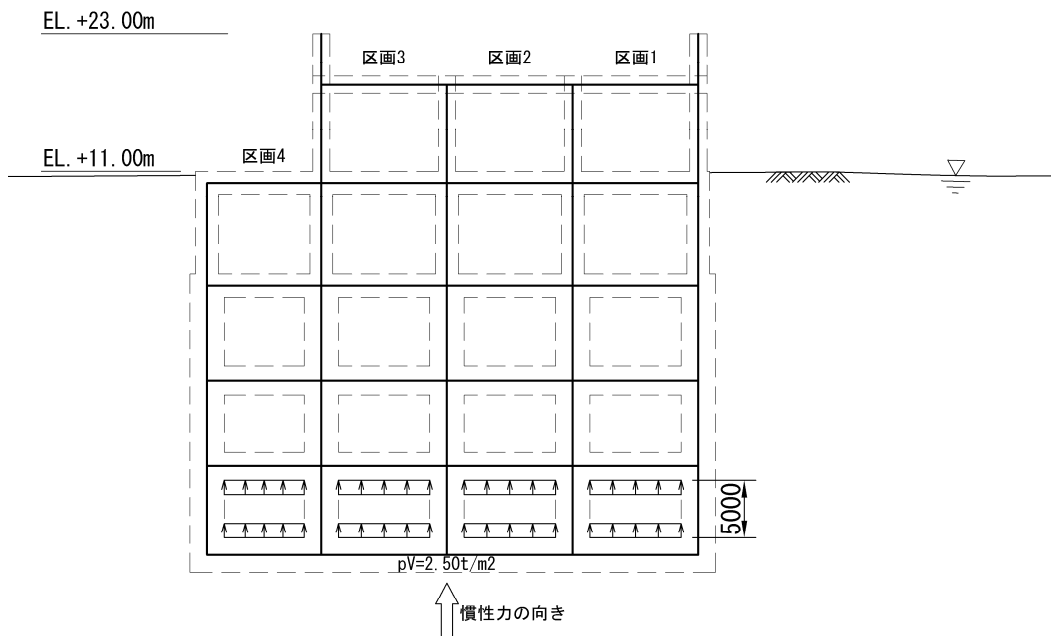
(2) 鉛直動による動水圧図 (南北方向⑤-⑤断面)
